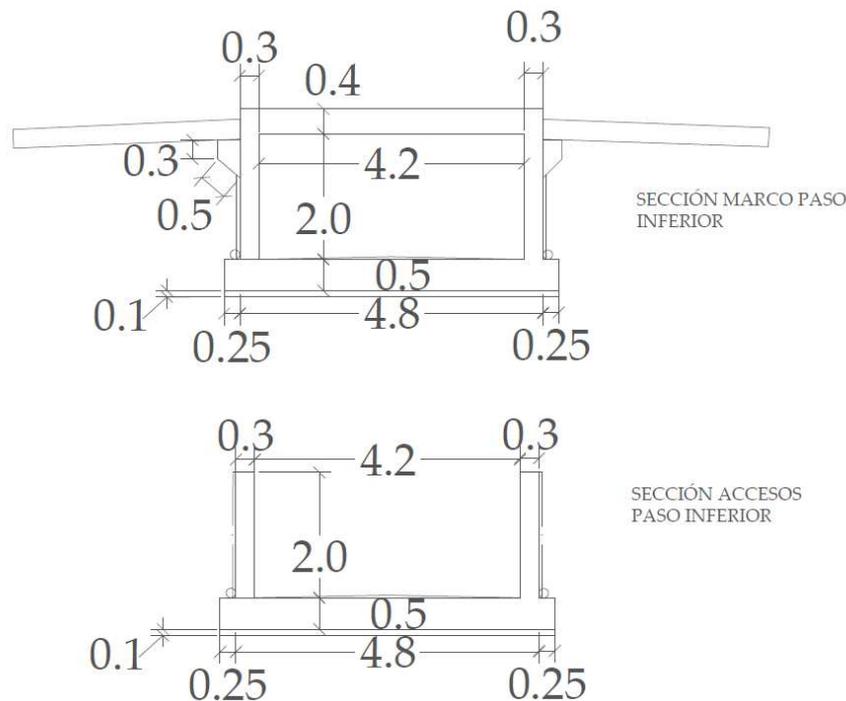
Parámetros geométricos de estructuras del cajón y de los accesos al paso inferior con dimensiones en metros. Fuente. Elaboración propia.
